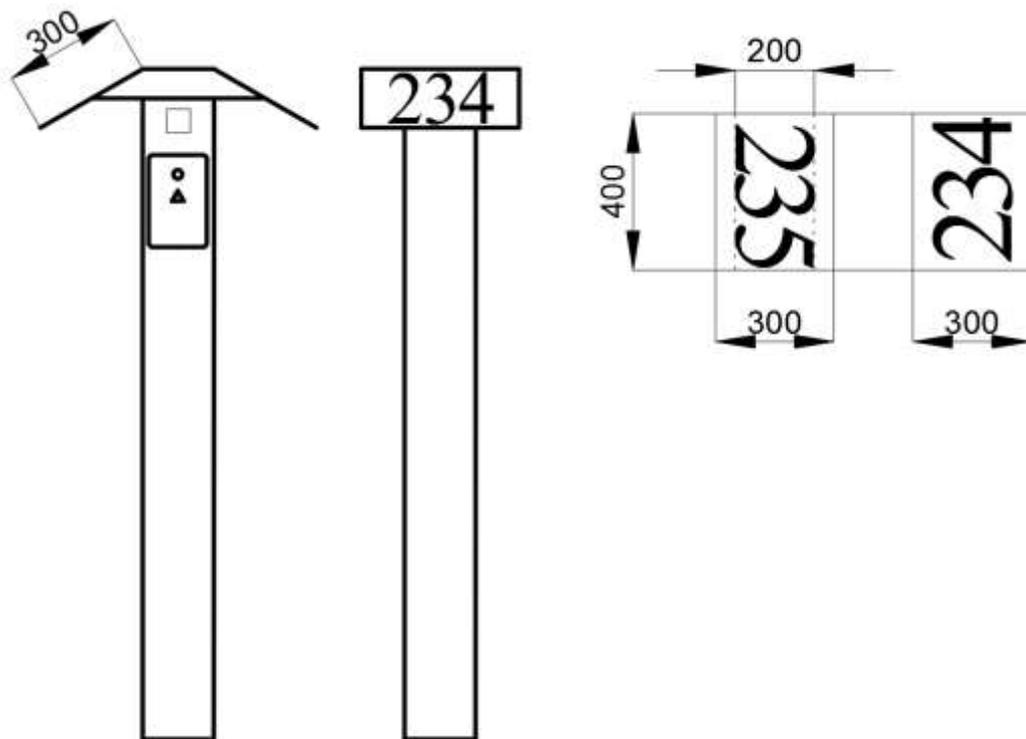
Внешний вид и установка километрового знака на КПЭХЗ
